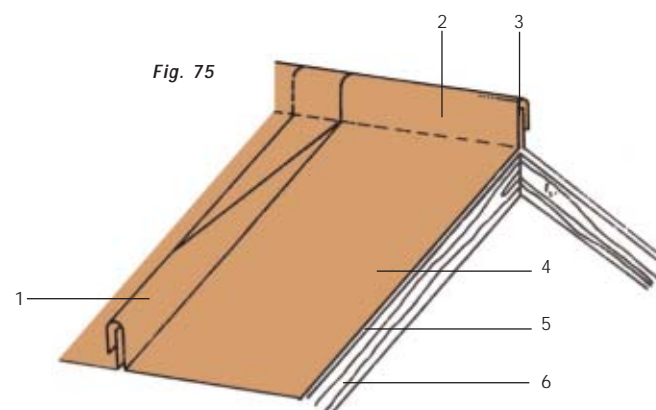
Detalhe executivo da junta elevada sobre a cumeeira - Continuação
